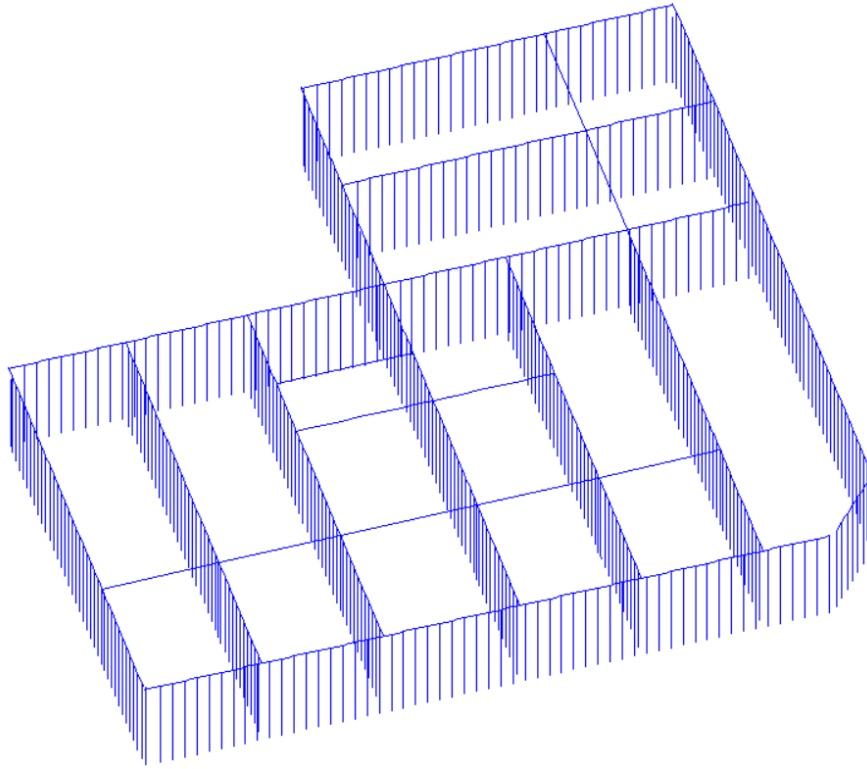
Imagen esquemática de la estructura de entramado ligero de la planta 0. Obtenida por ANGLE.
